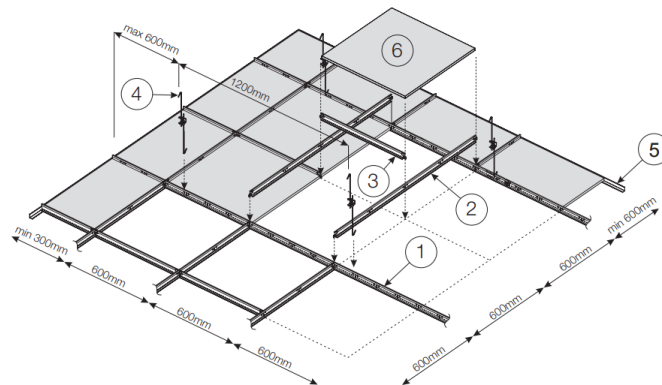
Esquema del sistema constructivo de estructura portante para falso techo suspendido
